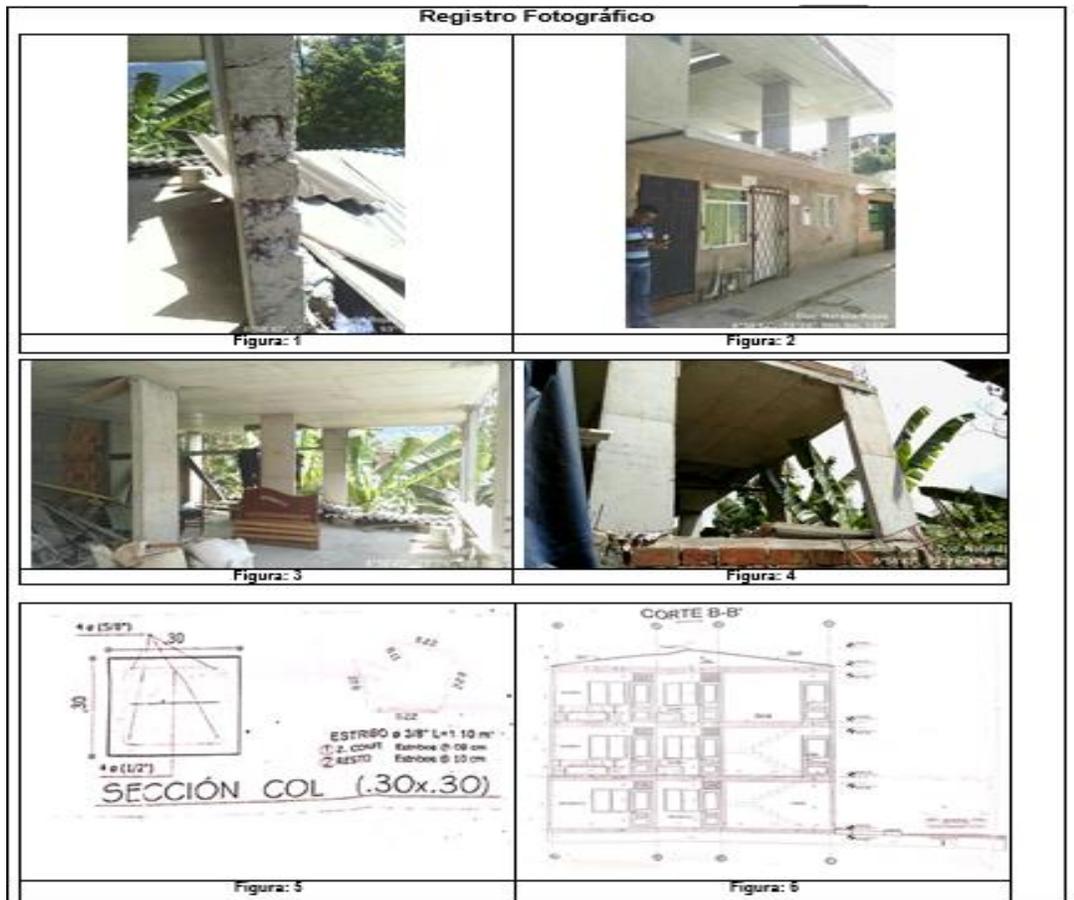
Informe Acta de Inspección Ocular Obra San Silvestre
